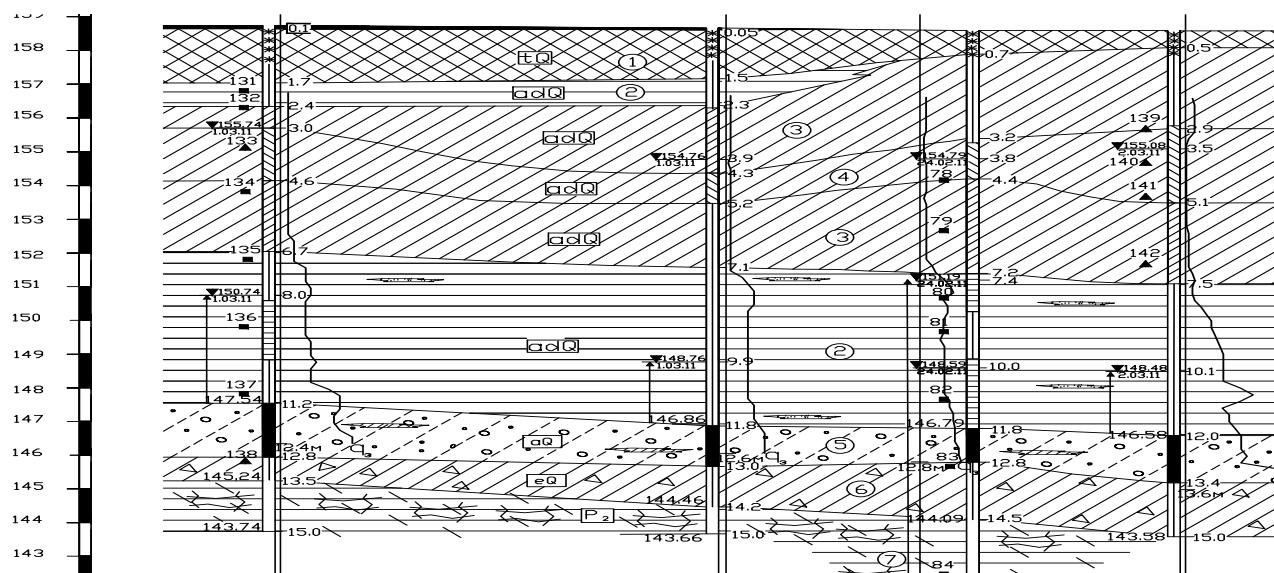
Геологический разрез опытной площадки №1 (г. Пермь)
